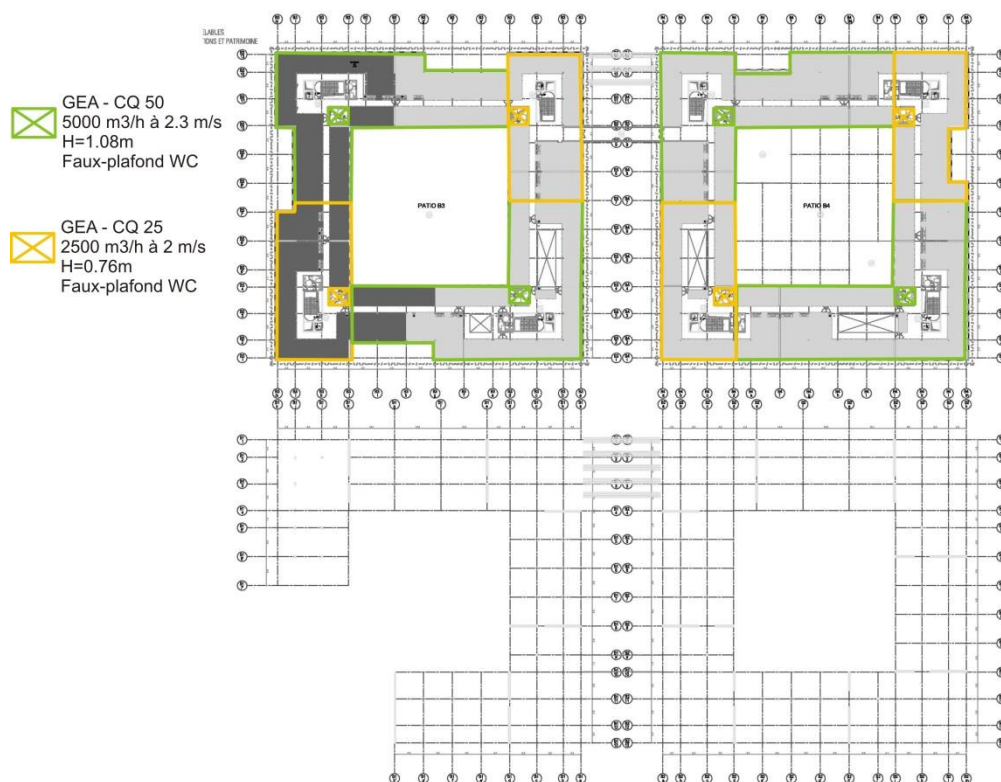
Plan d'implantation des CTA – B3B4 R2
